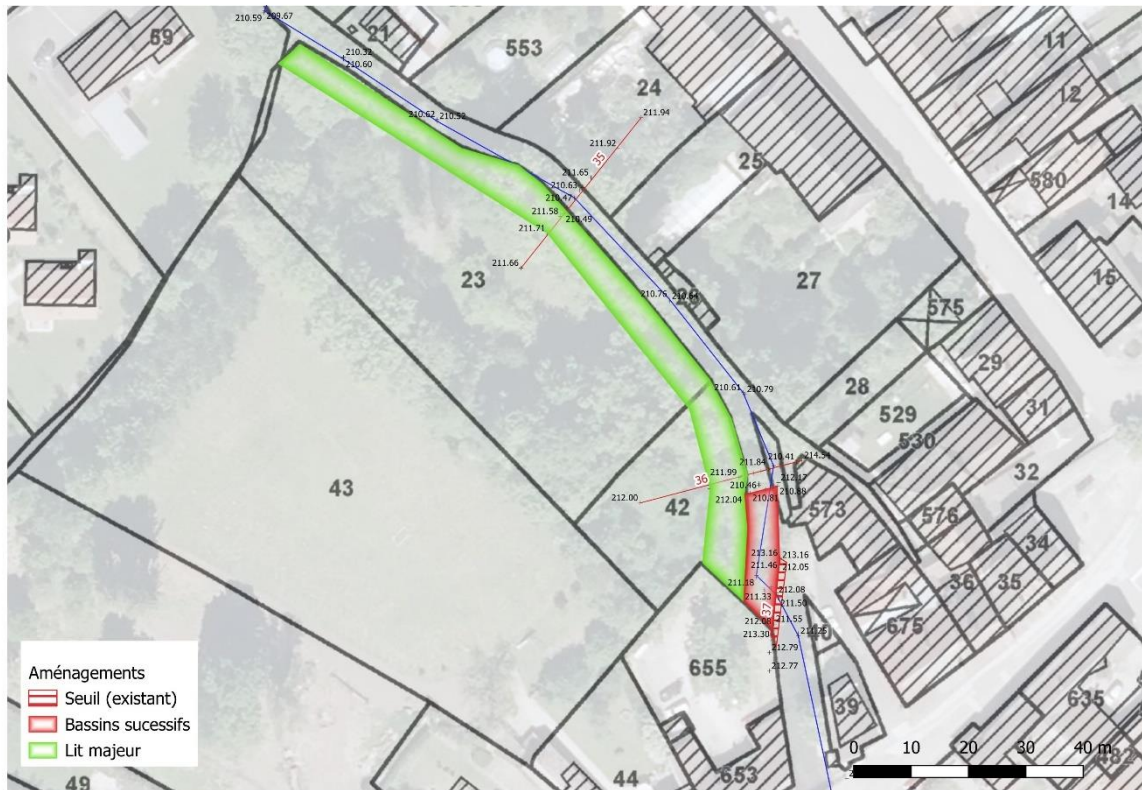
Franchissabilité du barrage Amiôt, plan des travaux
